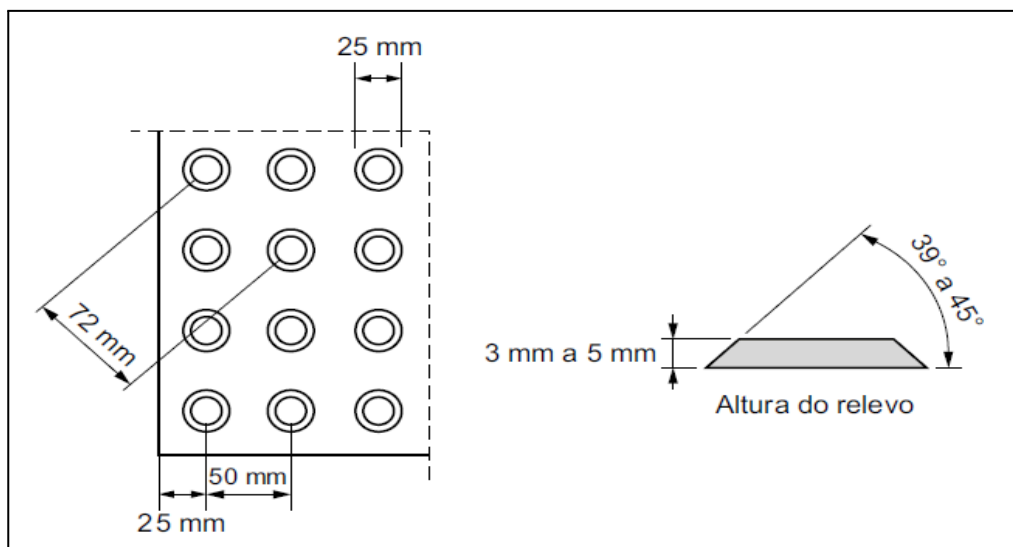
Dimensões do Piso Tátil de Alerta. (ABNT NBR 16537:2016)
